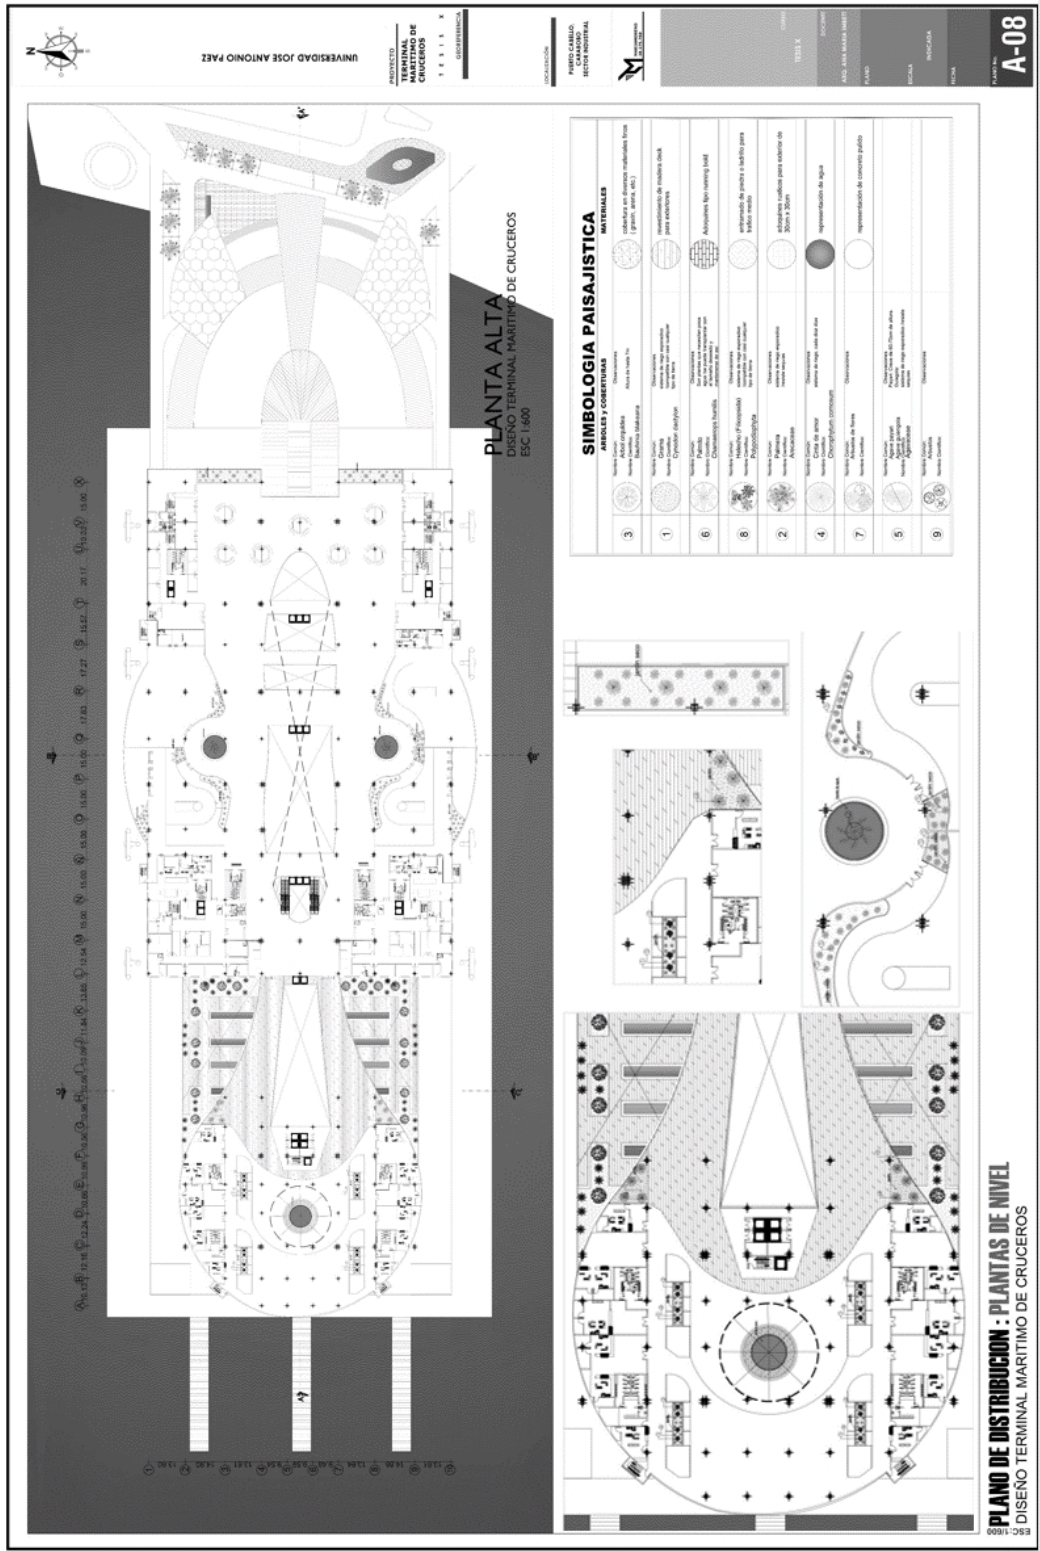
Plano de paisajismo de planta alta (Nivel +19.75)
